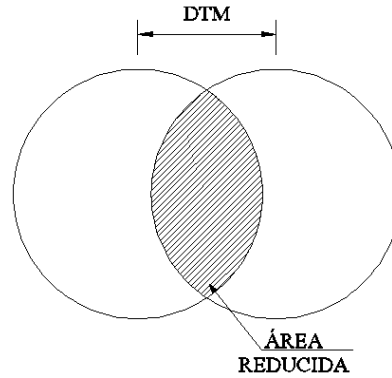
Vista en planta de reducción del Área de aislador debido a DTM.
